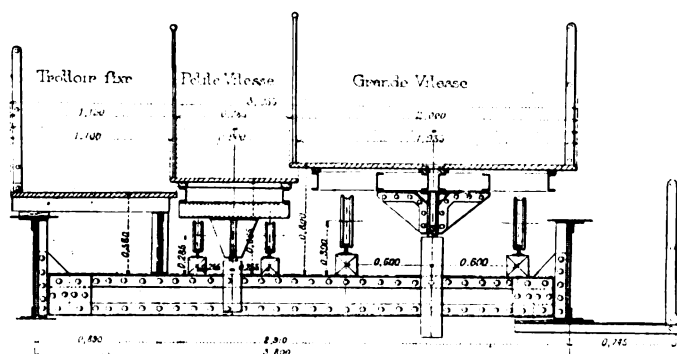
Coupe transversale de la plate-forme mobile : Viaduc à poutres pleines et galets de soutien.
